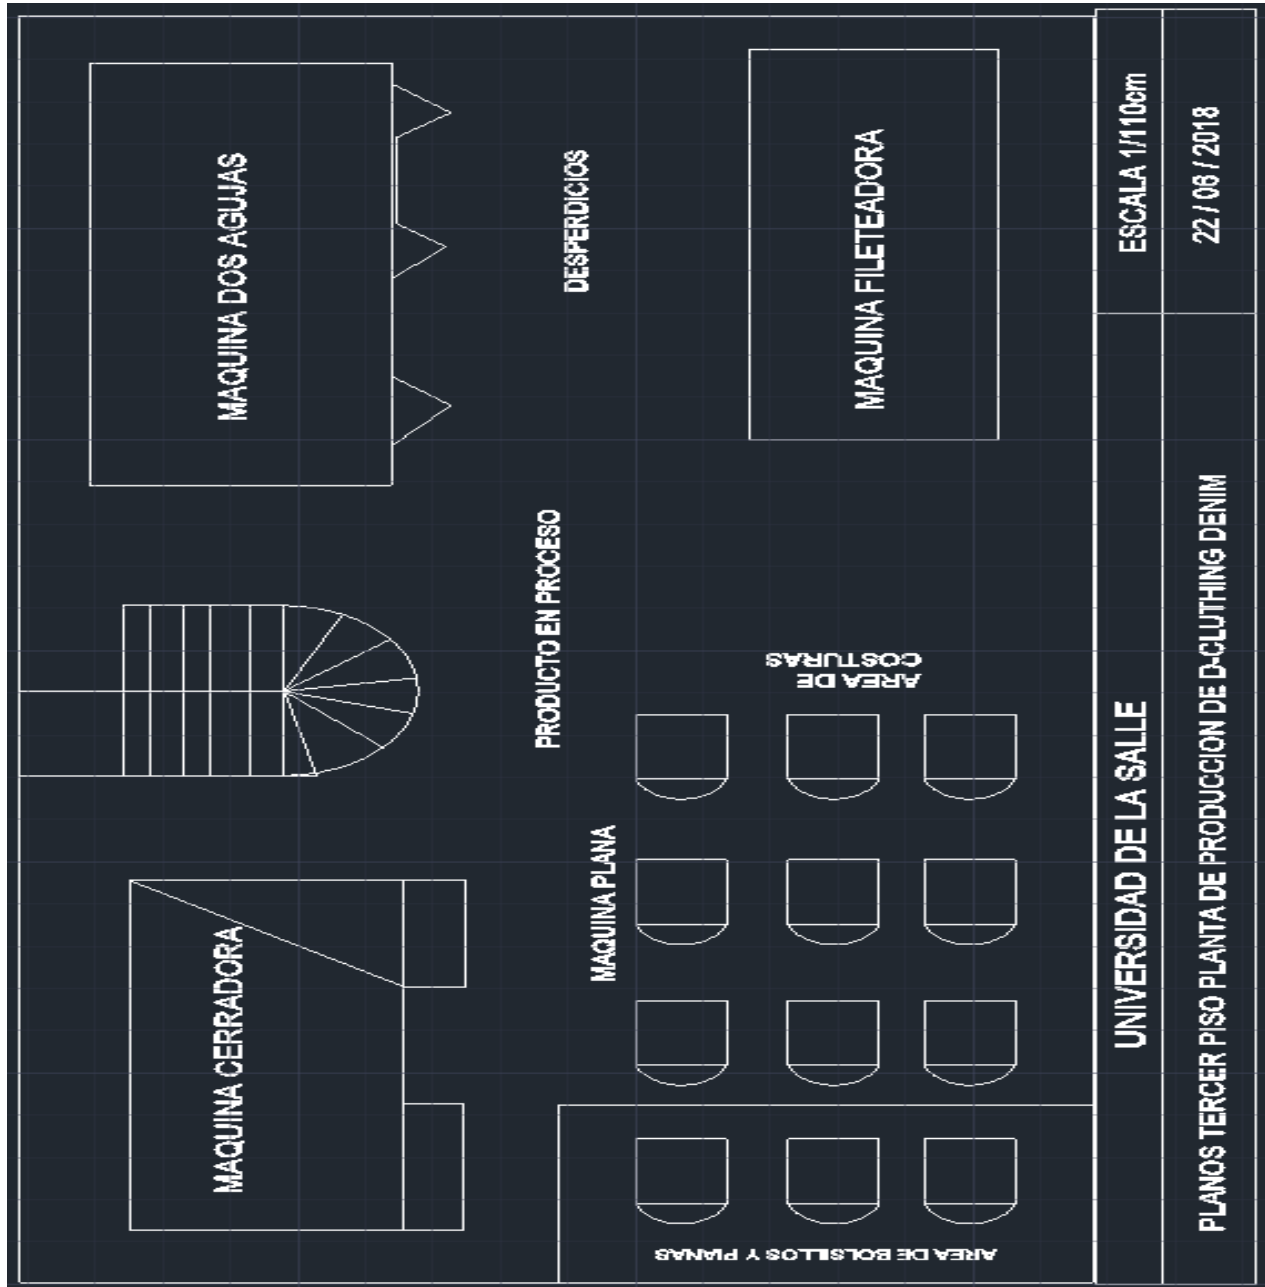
Planos tercer piso D-Cluthing Denim LTDA.
